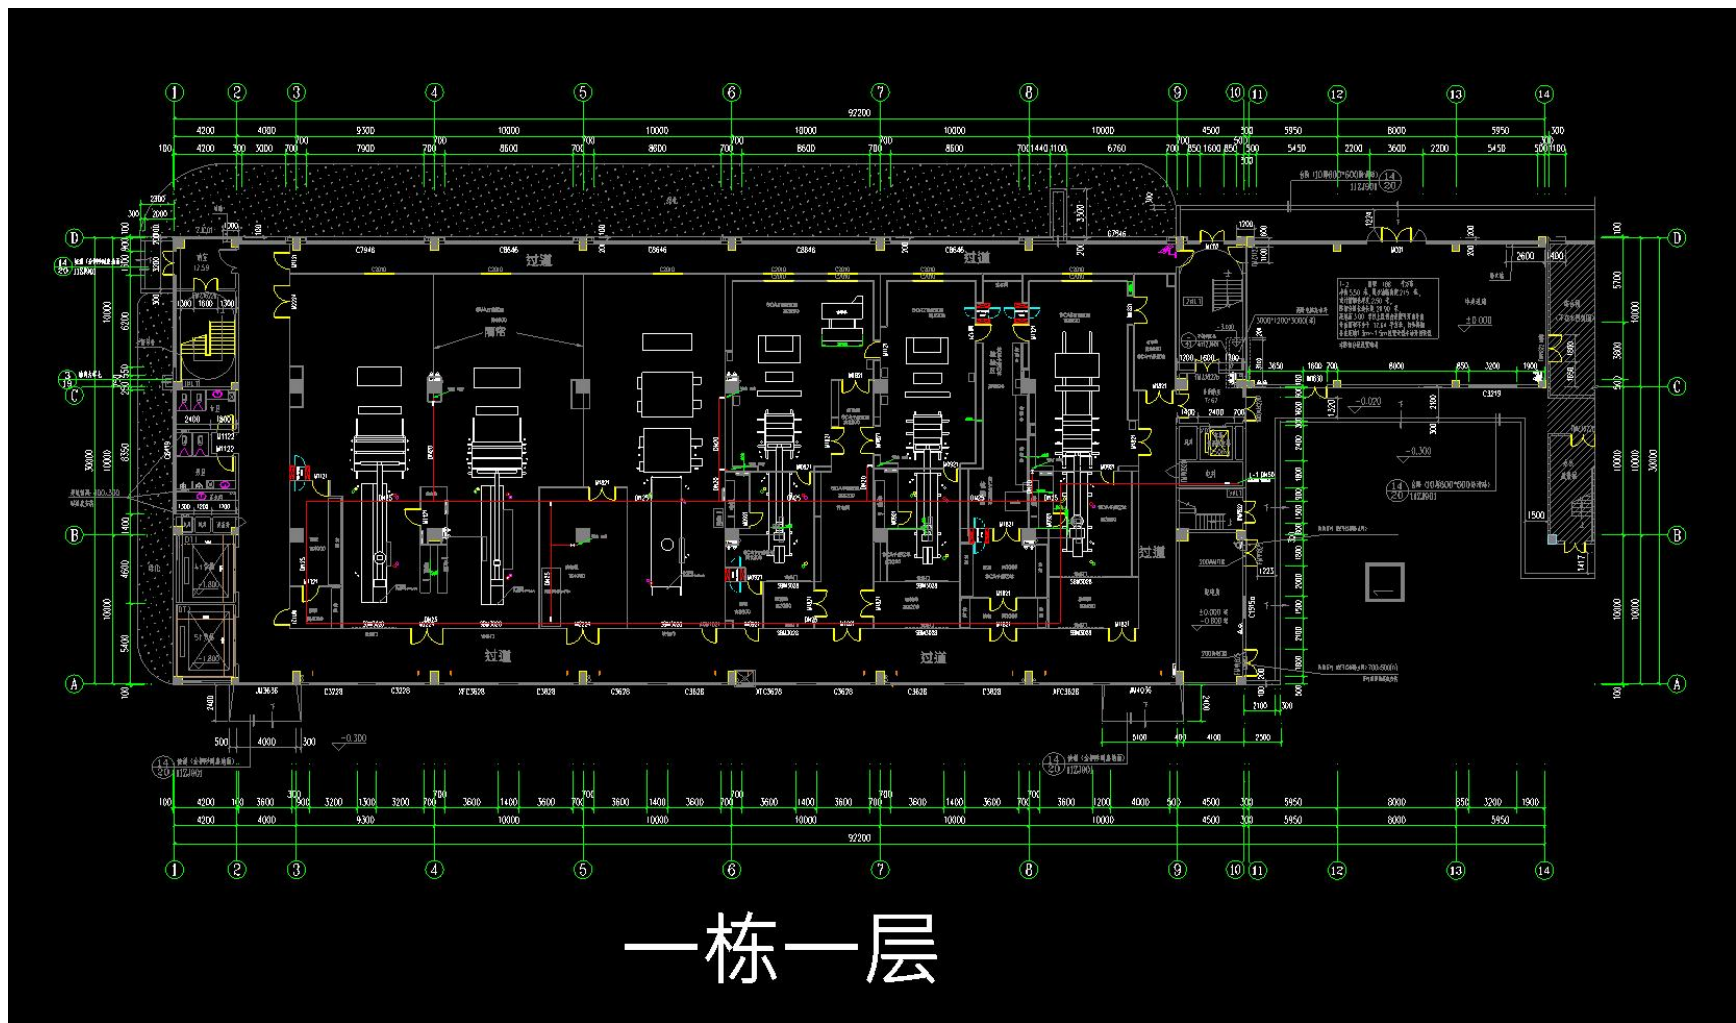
项目总平面布置图 (1 栋 1 层)
